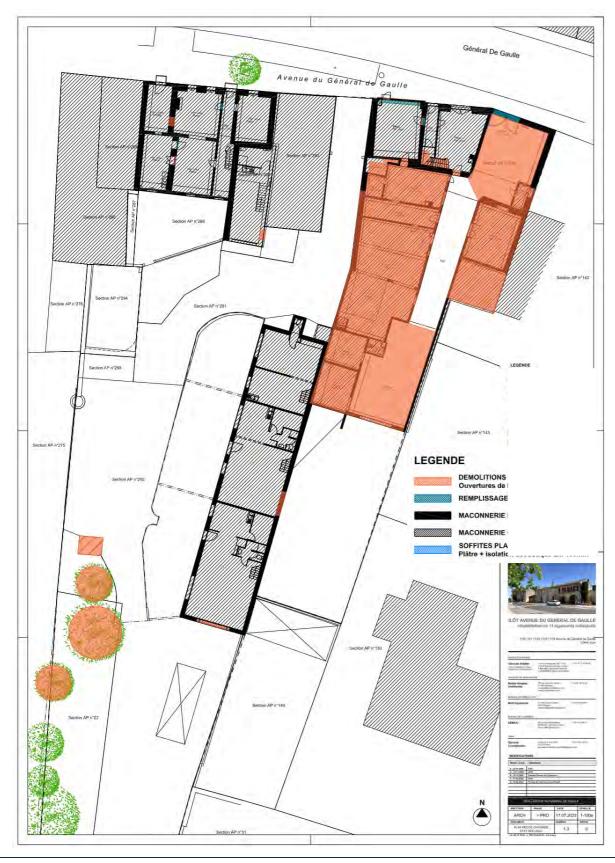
Plan des travaux à réaliser (rez-de-chaussée)
